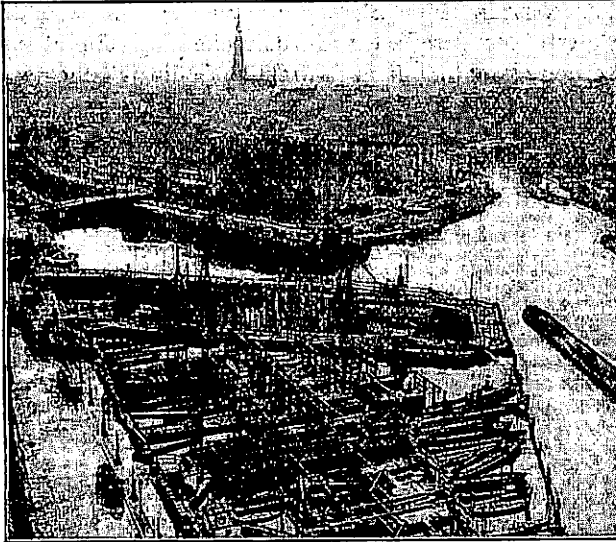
Spreekreuzung Inselbrücke, Bauabschnitt I (nach J. Bousset).
